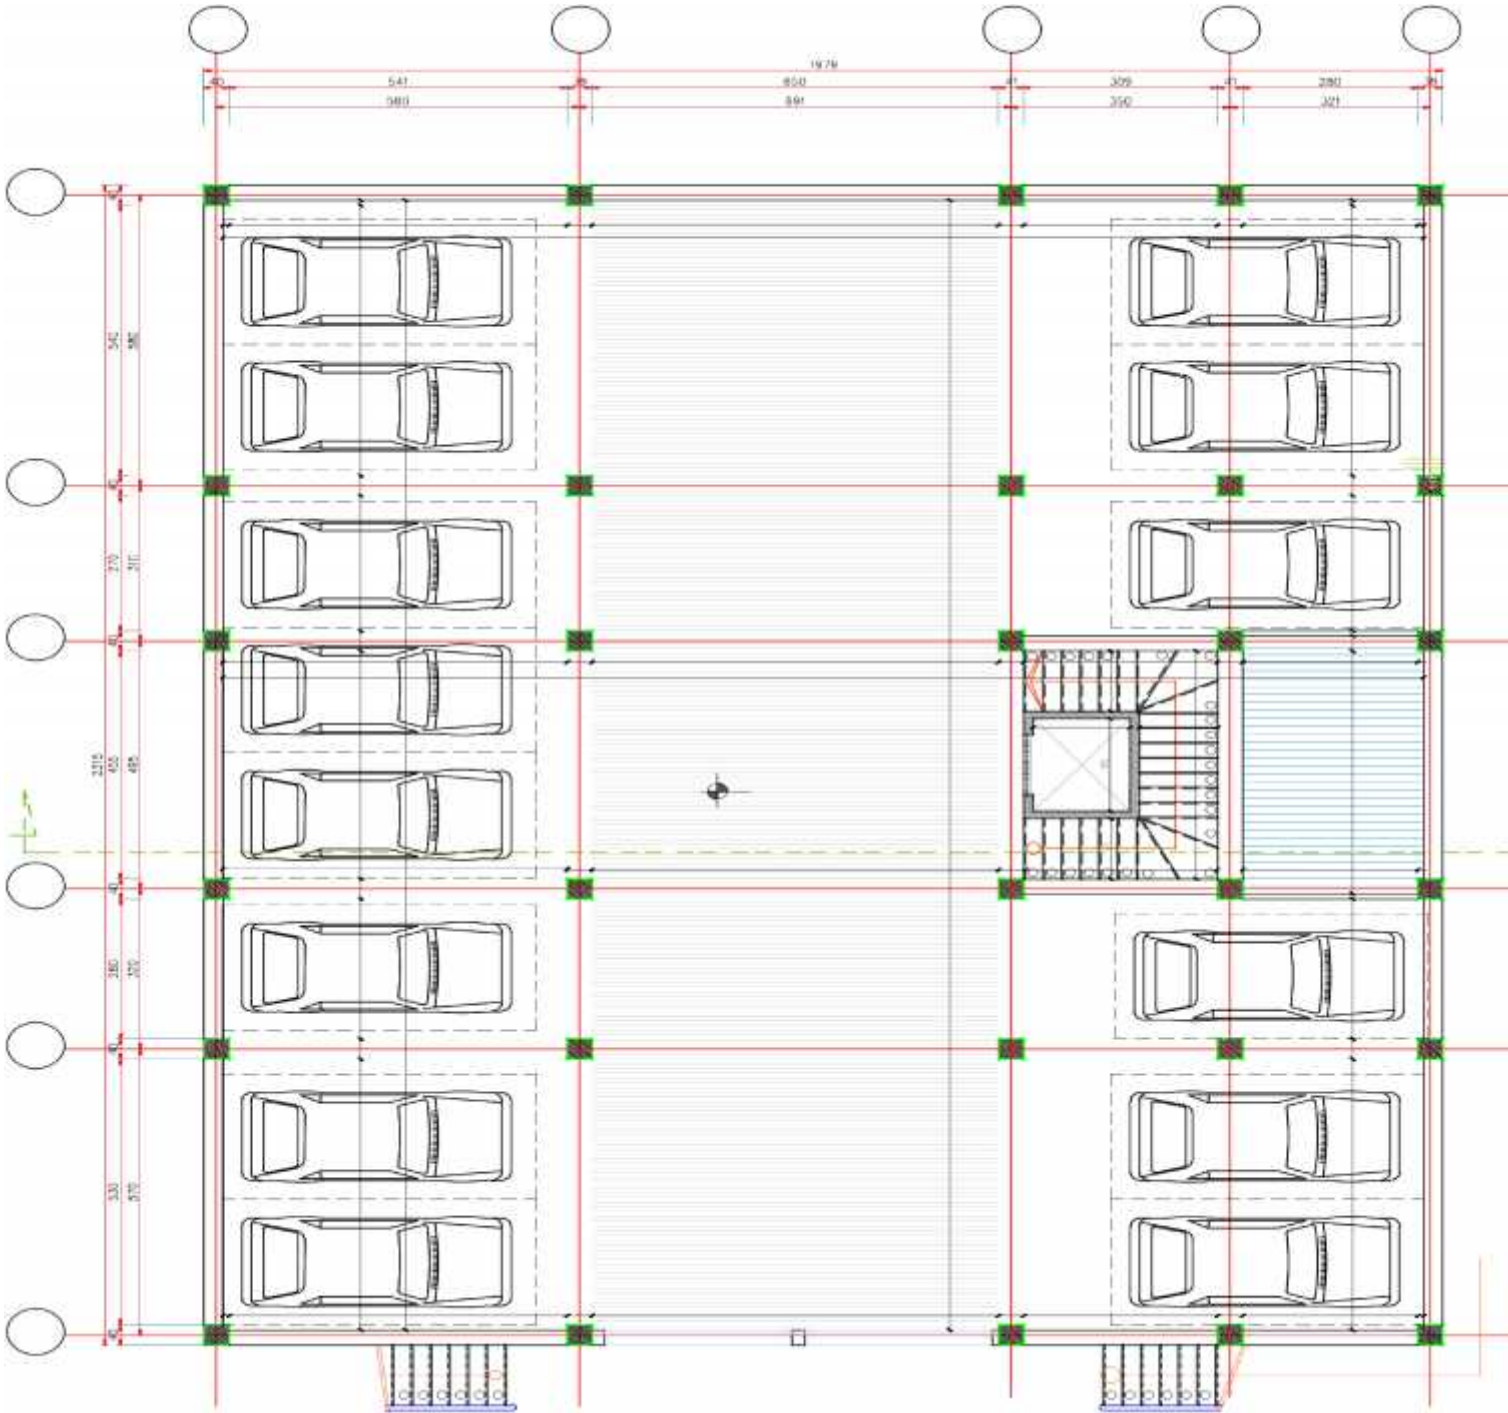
Vue en plan niveaux S-SOL de la structure
